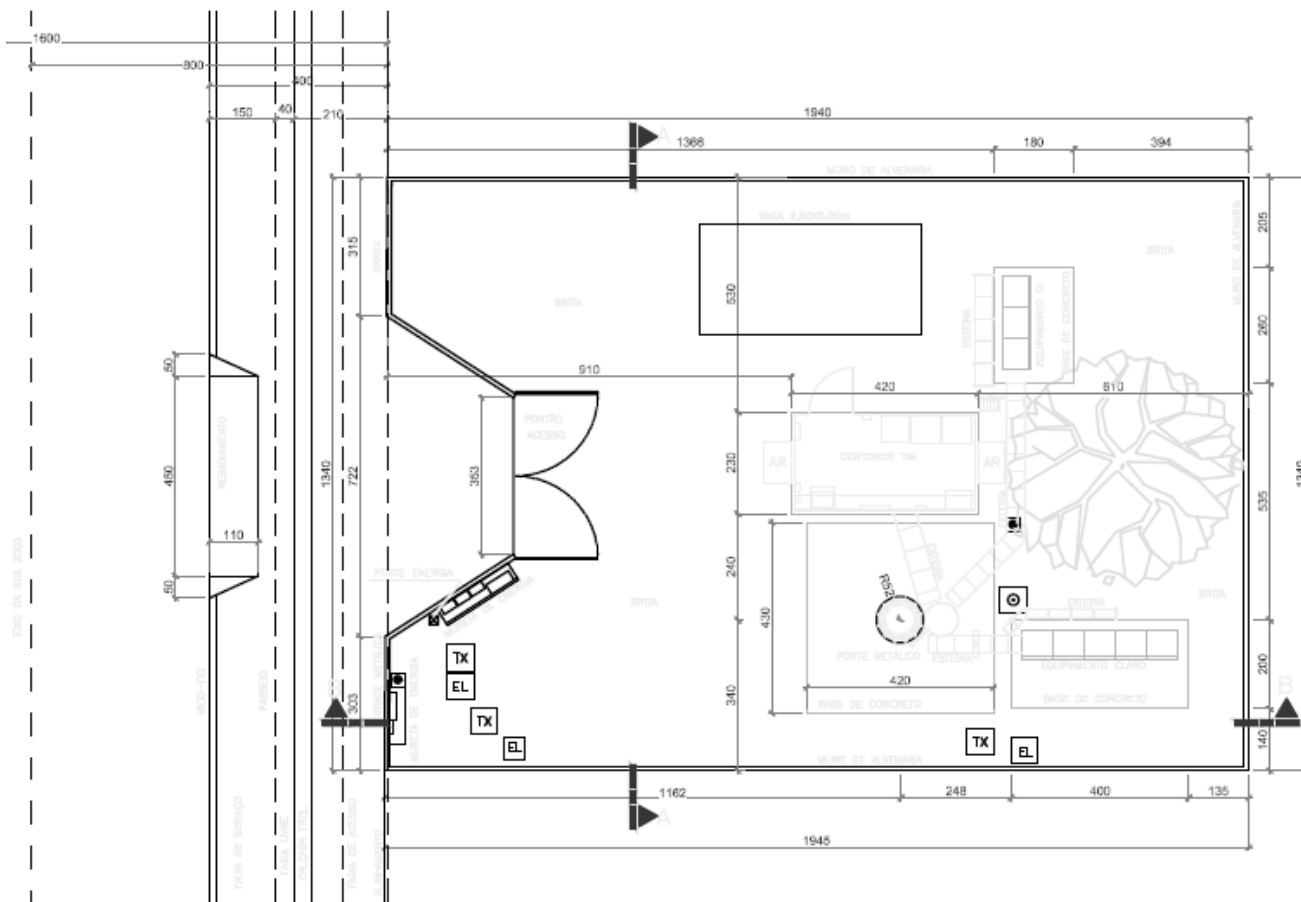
Recorte do projeto de instalação, apresentando a disposição dos equipamentos no site.
